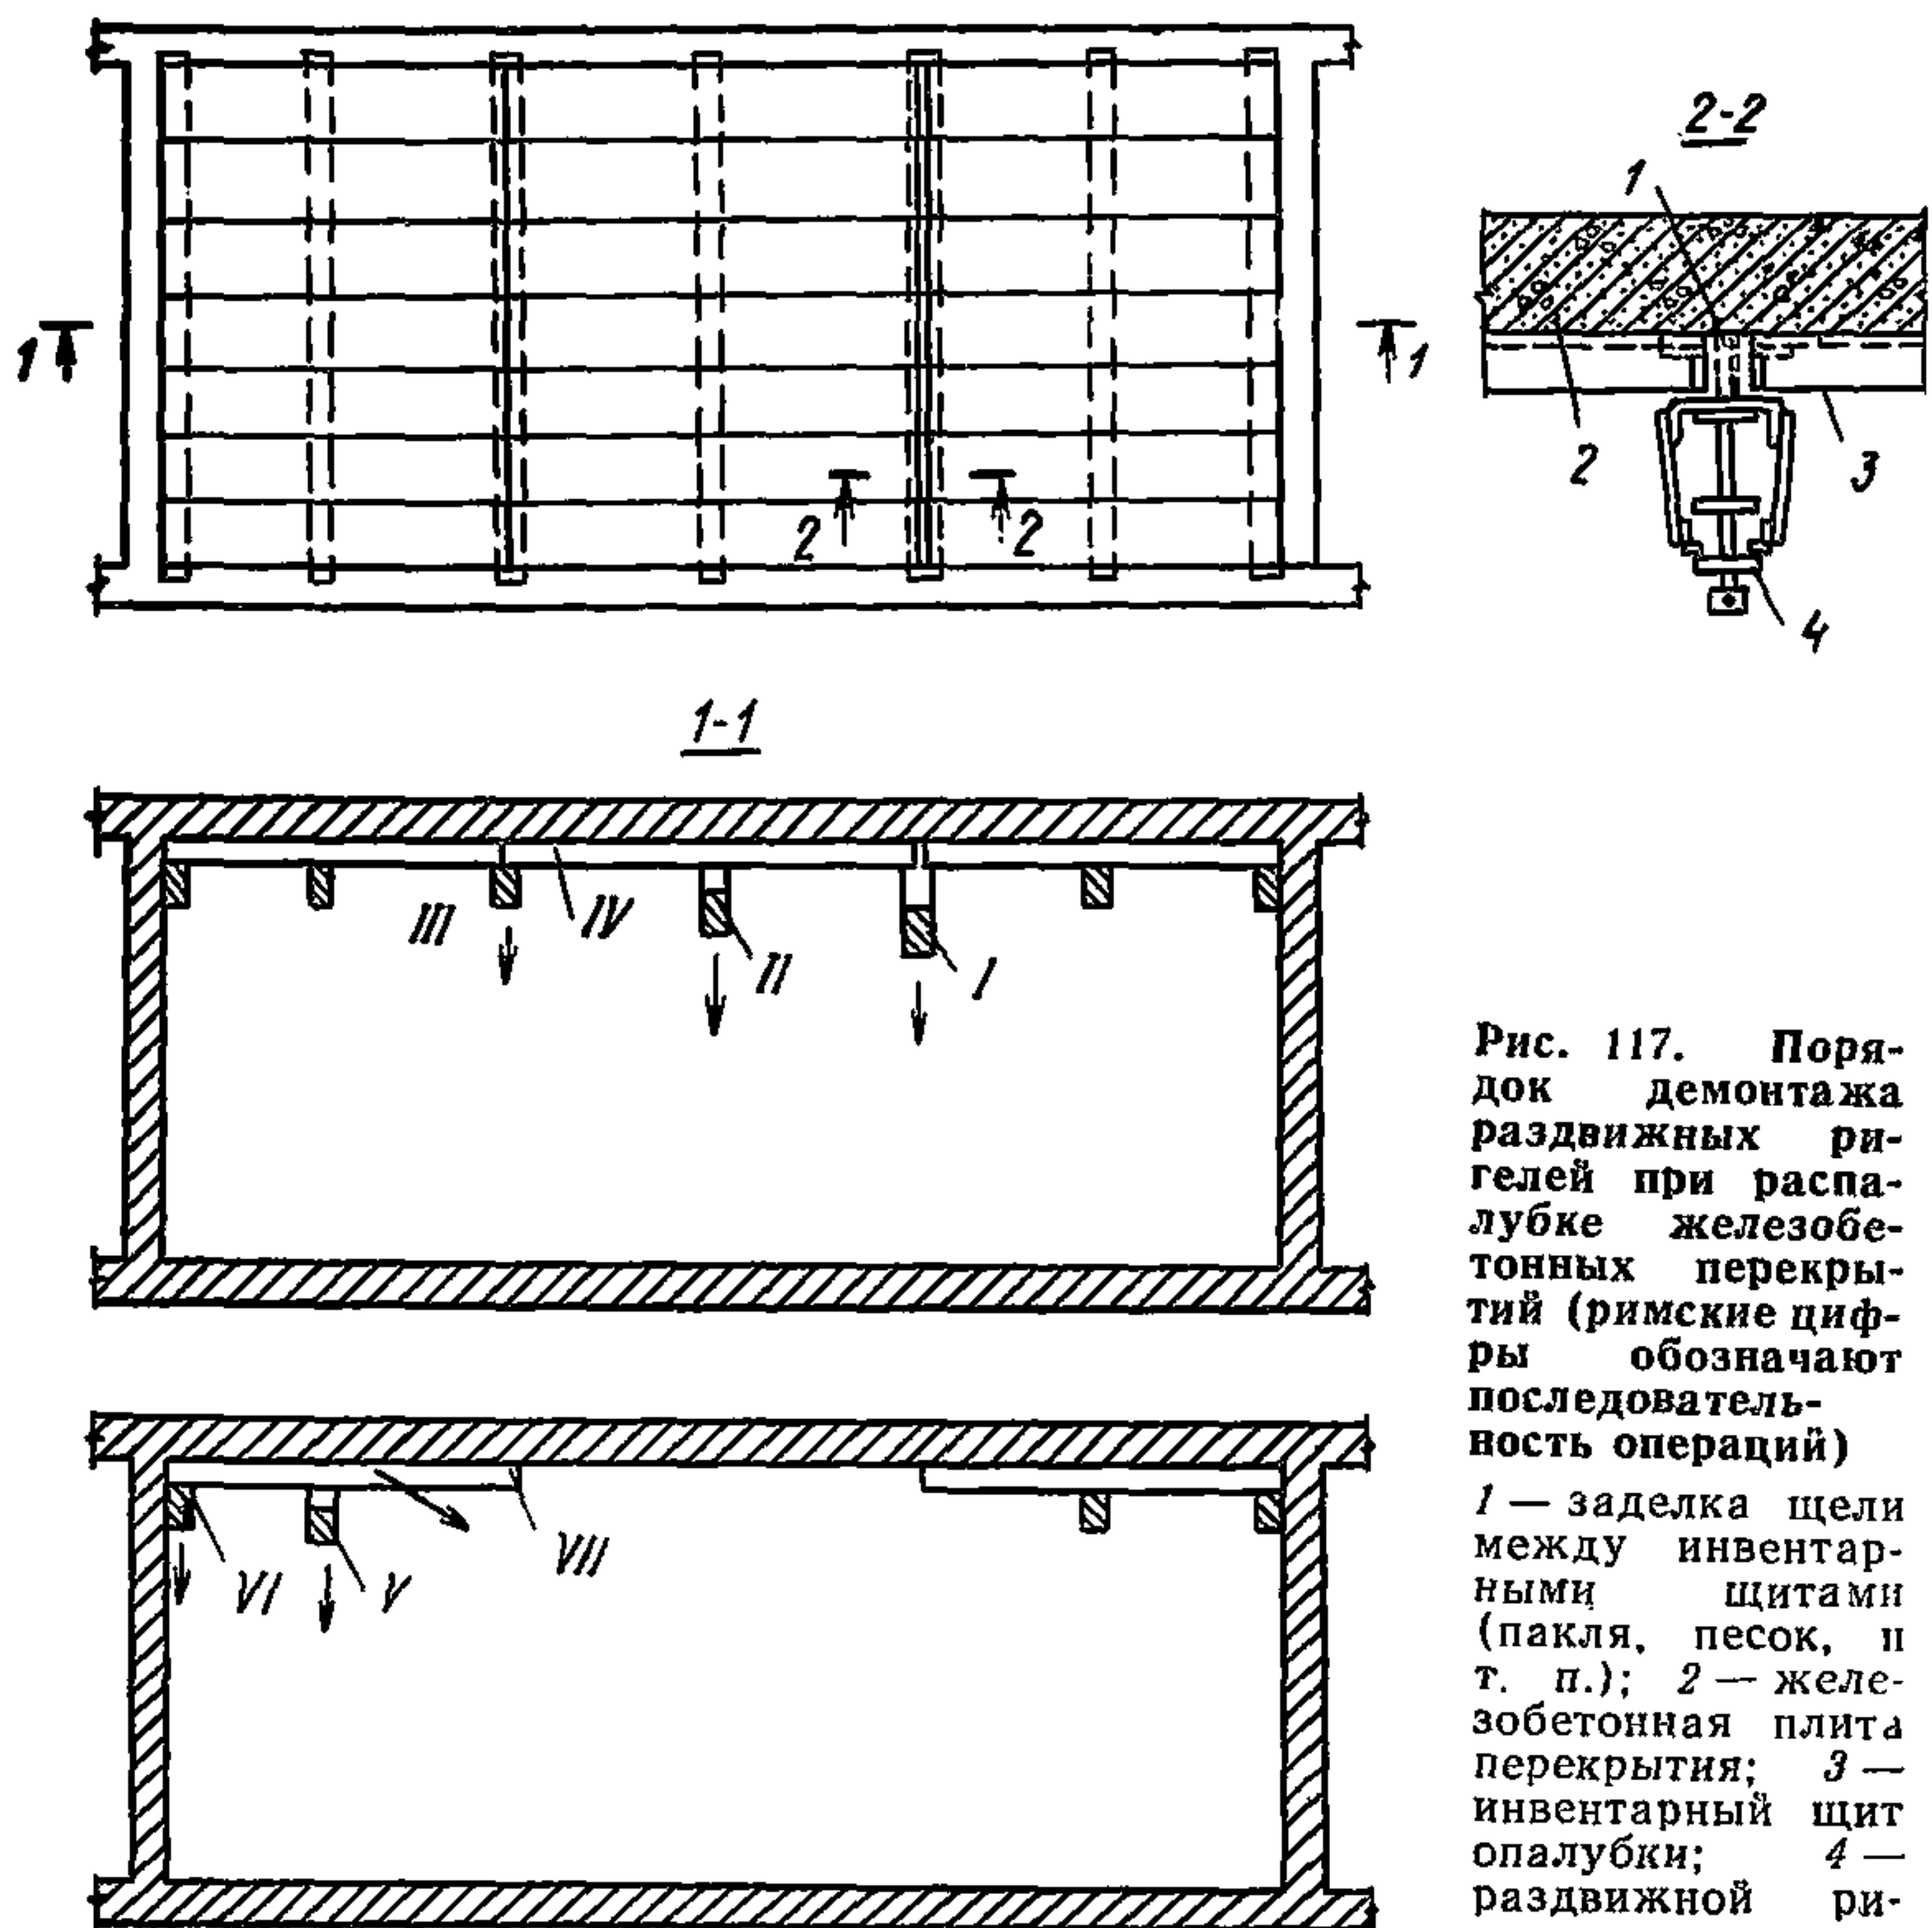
Порядок демонтажа раздвижных ригелей при распалубке железобетонных перекрытий (римские цифры обозначают последовательность операций)
